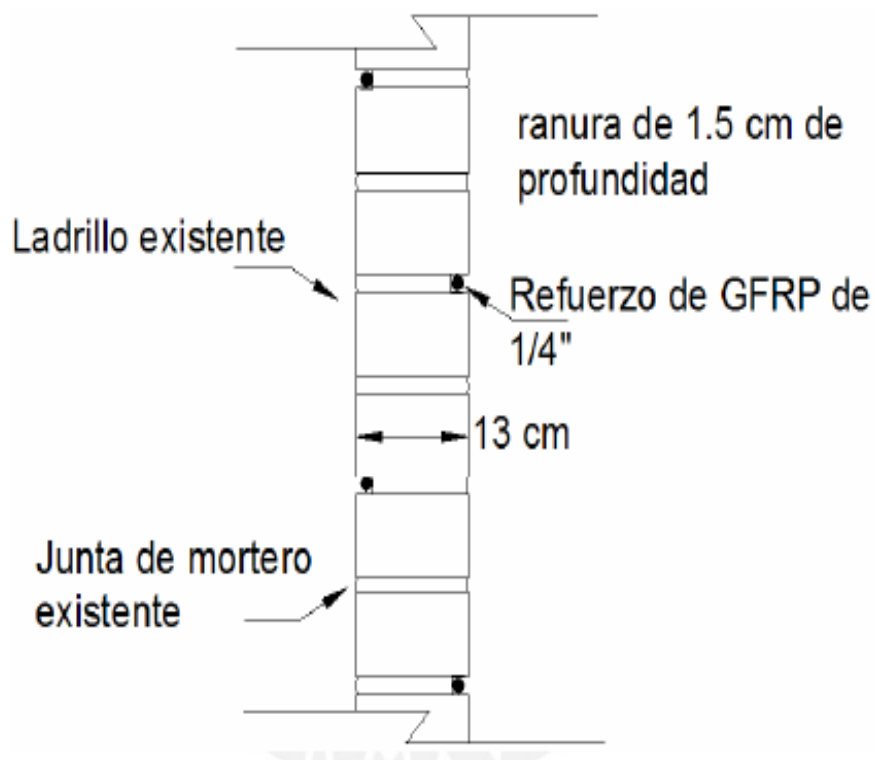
Esquema de colocación del refuerzo con varilla de polímero reforzado con fibra de vidrio GFRP (Fuente: Loayza, 2008)
